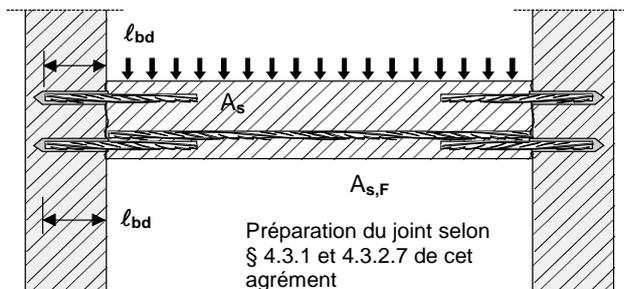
Recouvrement d'armatures pour la liaison de dalles et poutres
